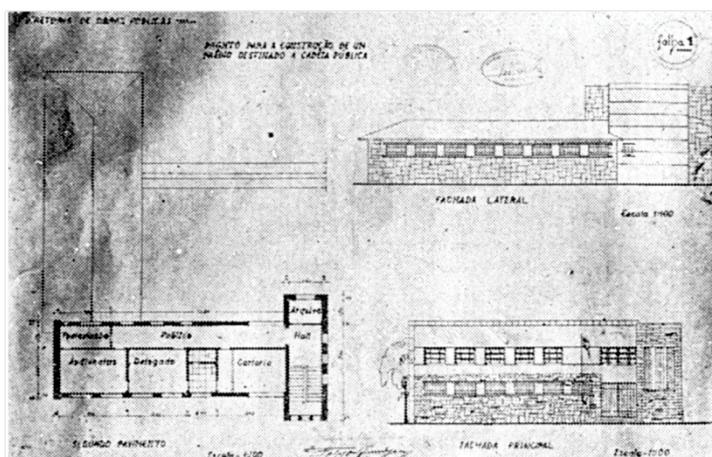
Planta do Presídio de Itajaí. Jornal do Povo, Itajaí, 30 de outubro de 1940.
